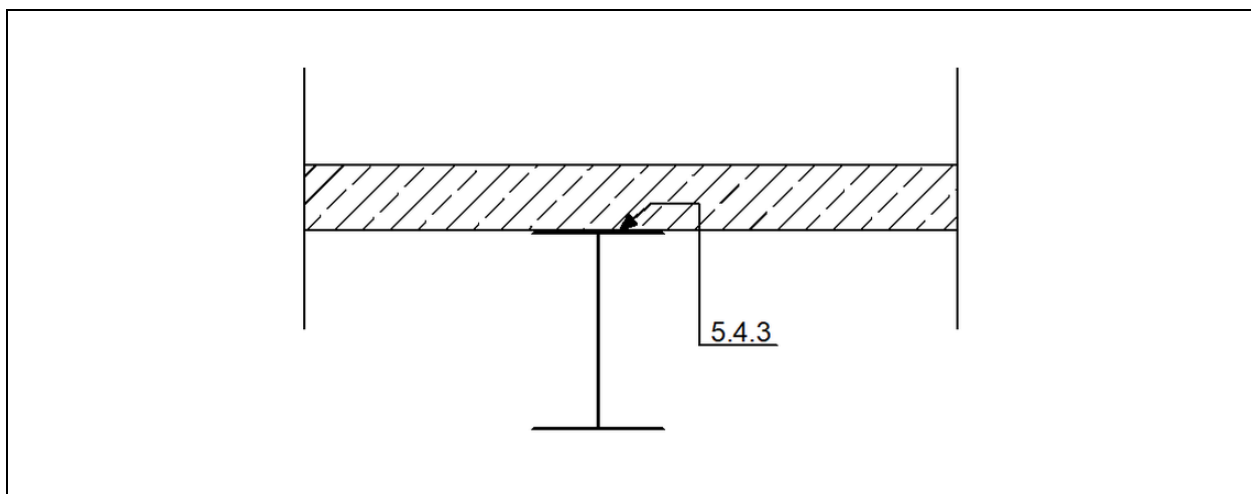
Detailquerschnitt von auf Stahlträgern aufliegenden Betonfertigteilen ohne Verbund
